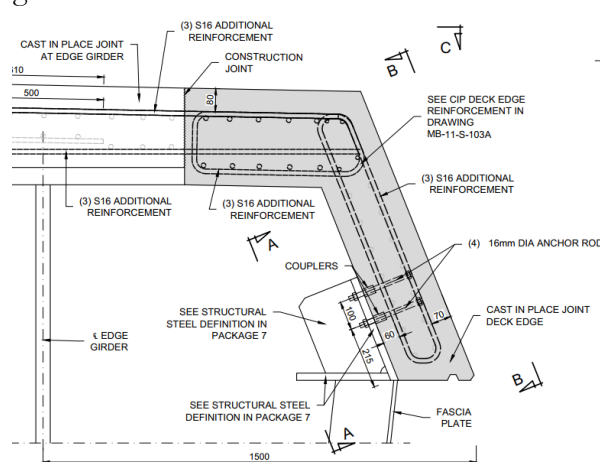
Anclaje del cerramiento metálico lateral en el faldón de hormigón
